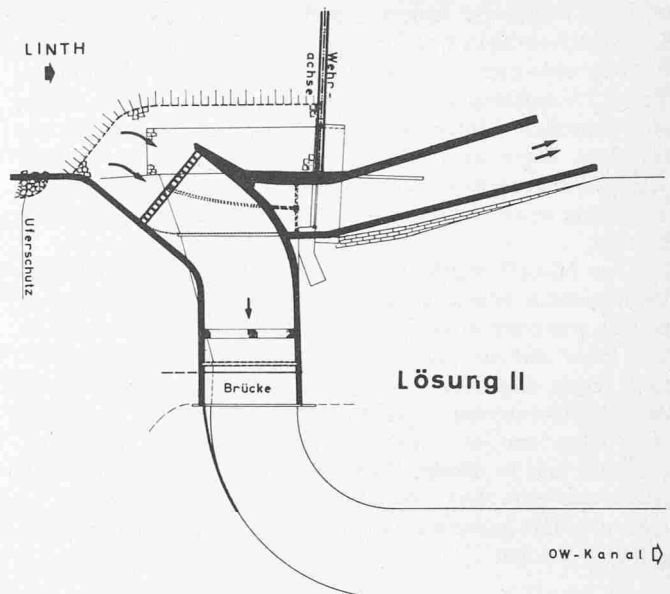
Grundriss der Lösung II der Wasserfassung Mollis/Linth
